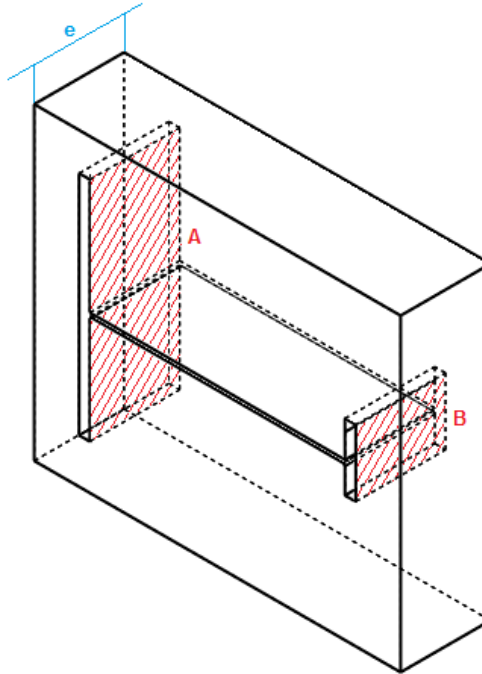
Planos de aplastamiento A y B para cuchilla fija
